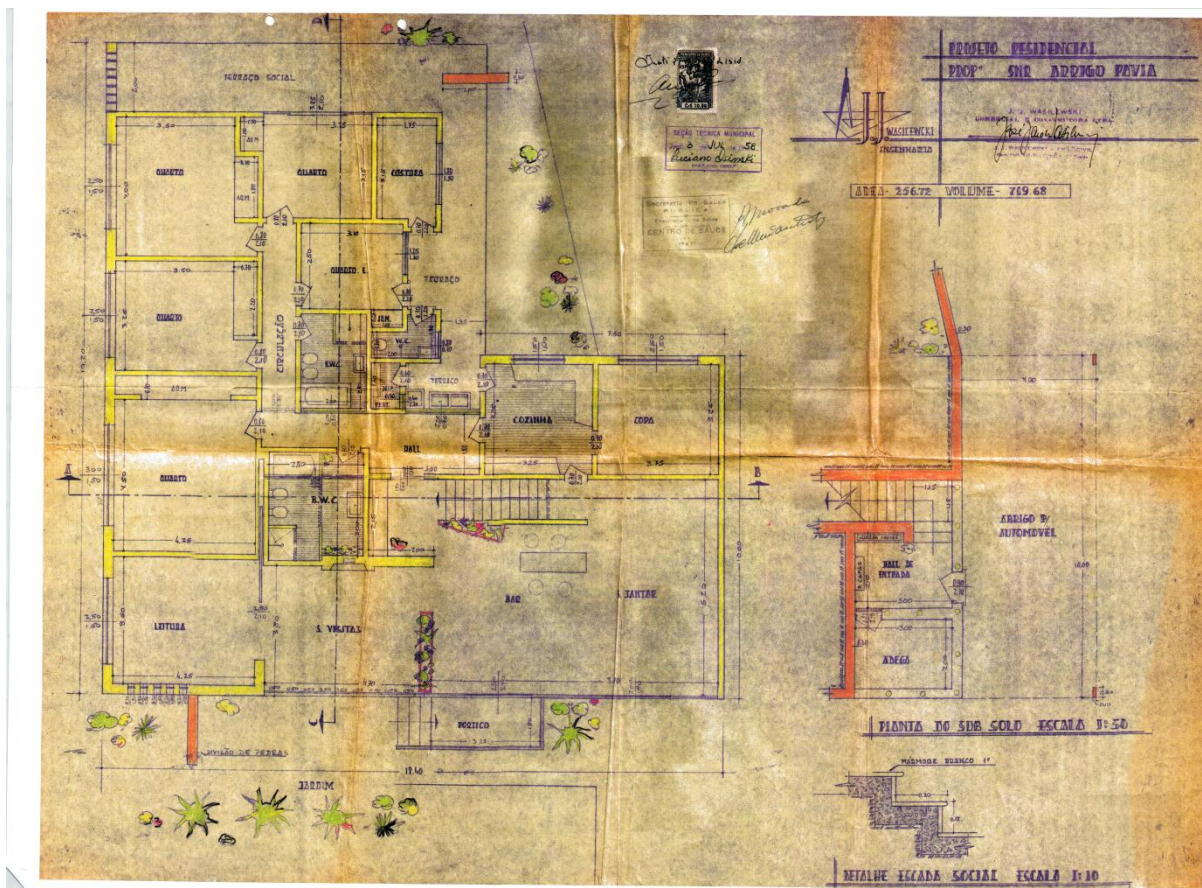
Projeto original da planta baixa da residência Família Pavia - 1958
